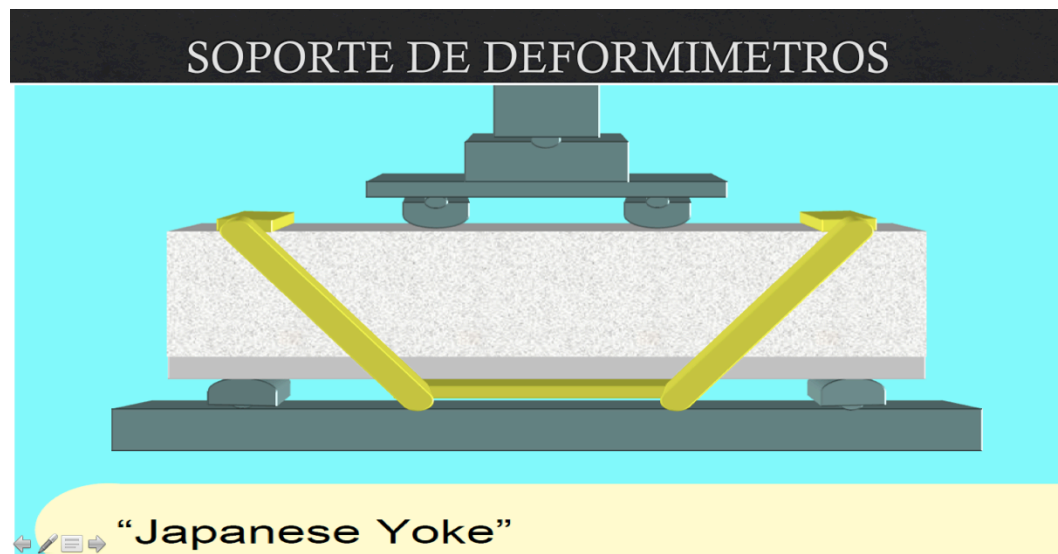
Esquema de la colocacion de deformimetros sobre viga de concreto.<sup>46</sup>
